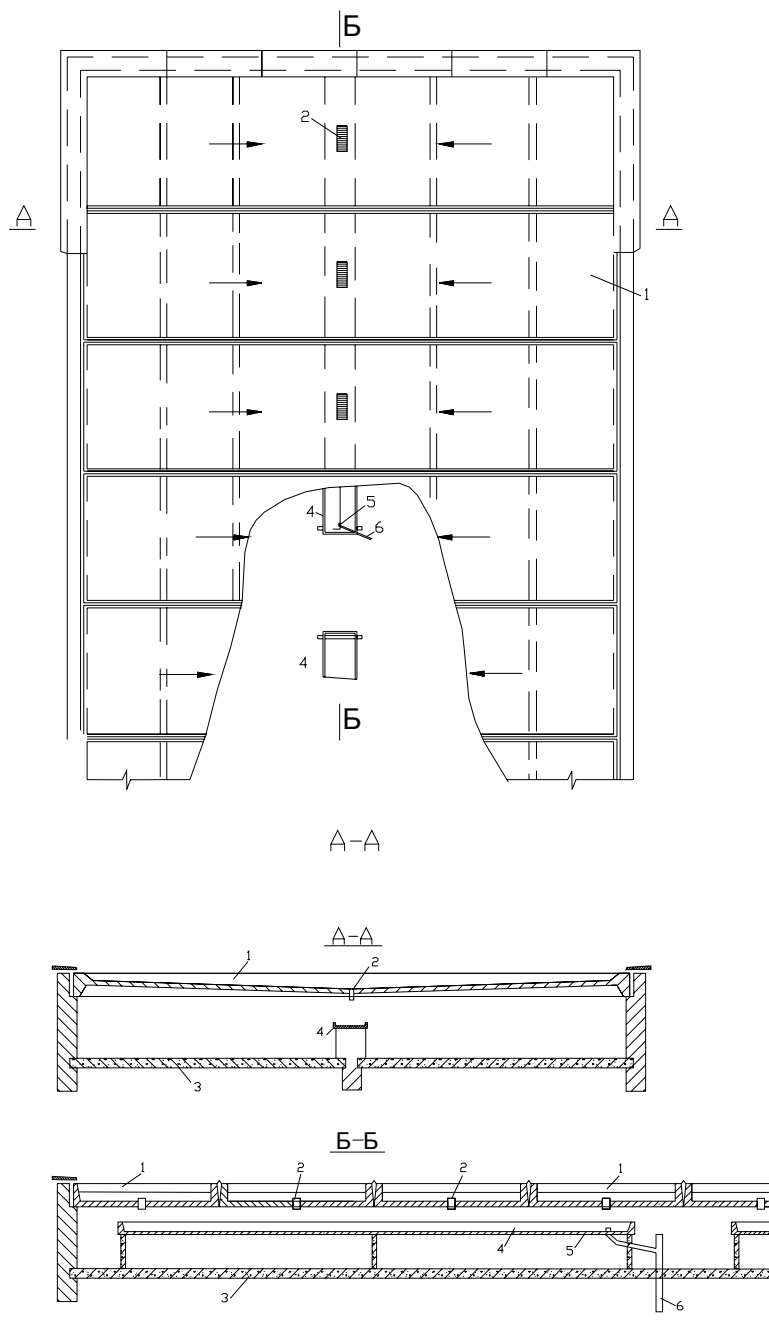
Безрулонна крівля: 1-залізобетонні покрівельні панелі; 2-водозливні отвори; 3-перекриття горища; 4-водозбірні лотки; 5-водоприймальні лійки; 6-водовідводи
